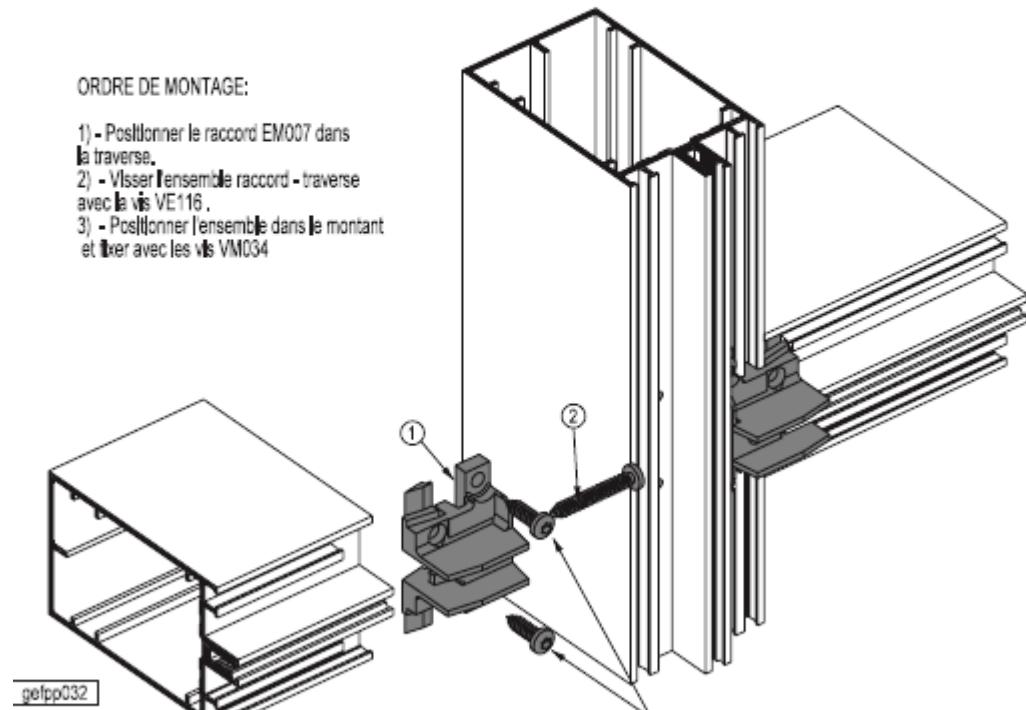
DETAILS D'ASSEMBLAGE ET DE MONTAGE MUR-RIDEAU ASPECT GRILLE-GAMME TECHNAL GEODE MX52
